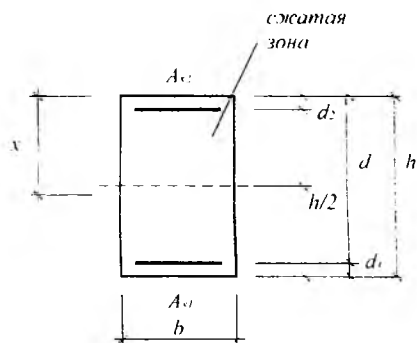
Расчетная схема элемента (к расчету по европейским нормам проектирования)
